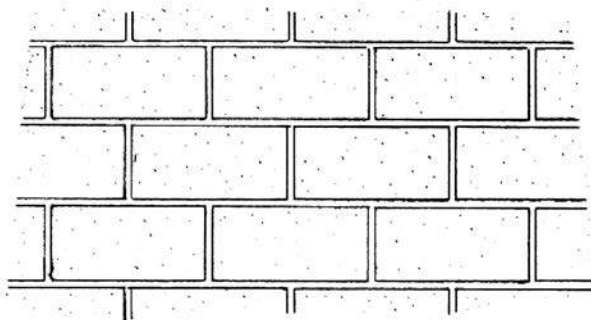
Mampostería traslapada (IMCYC, 1988).
